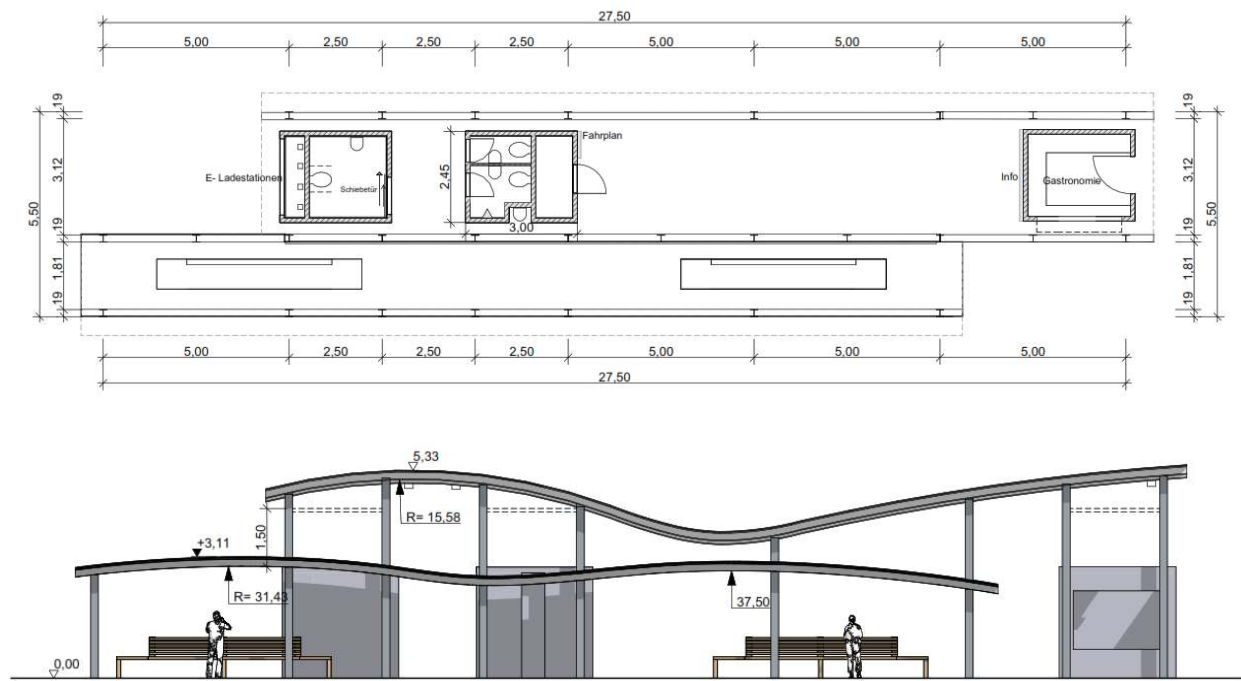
Bauliche Anlage Grundriss und Ansicht von Westen: Basicc (Entwurfsstand 2021.08.10).
